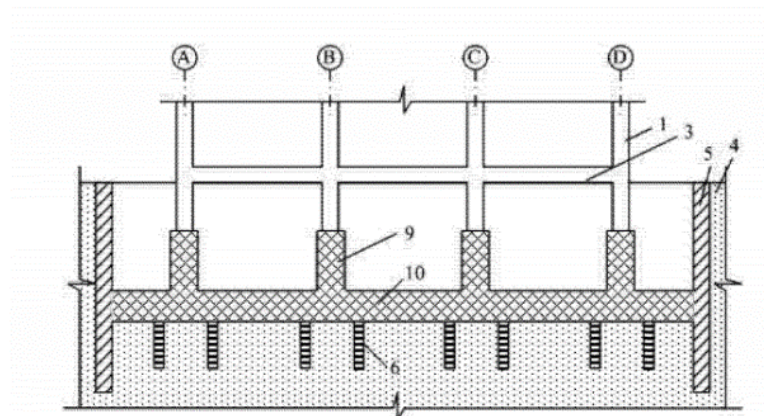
Схема устройства подземного этажа по патенту CN102182325B: 1 – колонна здания; 2 – столбчатый фундамент; 3 – перекрытие; 4 – грунт; 5 – подпорная стена; 6 – свая; 7 – амортизирующий колпачок; 8 – буросекущие сваи; 9 – новое основание колонны; 10 – новая фундаментная плита
